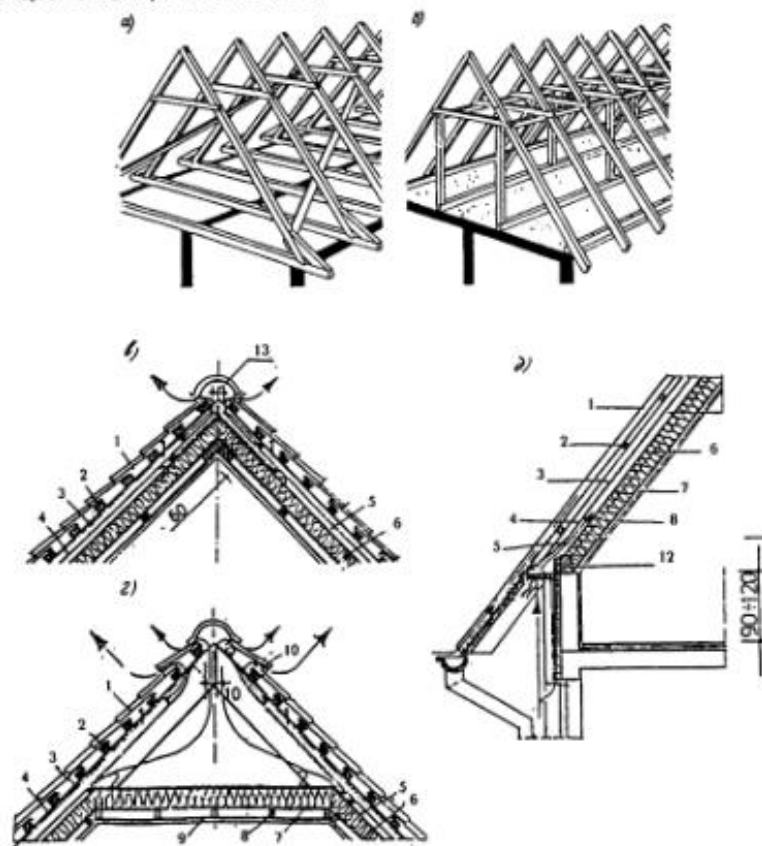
Несущие и ограждающие конструкции деревянных мансард: а – система висячих стропил мансарды; б – то же, наслонных; в – коньковый узел бесчердачной мансарды; г – то же, чердачной; д – карнизный узел; 1 – кровля; 2 – обрешетка; 3 – защитная пленка; 4 – контробрешетка; 5 – вентилируемая воздушная прослойка; 6 – утеплитель; 7 – парозоляция; 8 – деревянные рейки; 9 – гипсокартон; 10 – черепица с вентиляционной решеткой; 11 – вентиляционная решетка; 12 – мауэрлат; 13 – коньковая черепица
